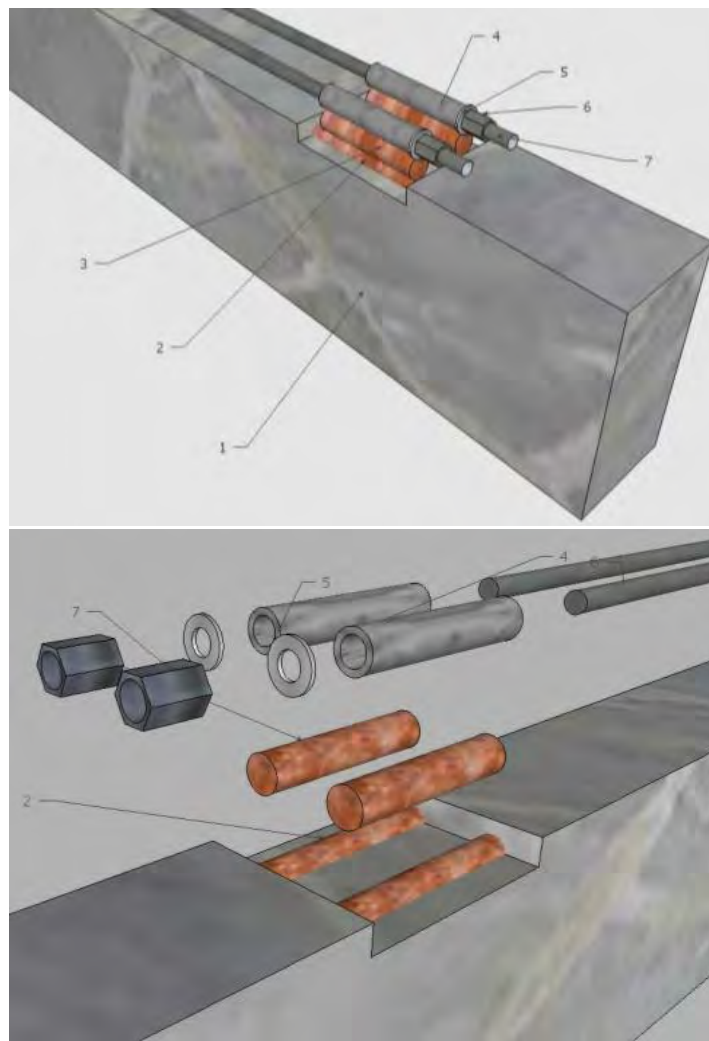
Схема монтажу необхідних елементів для кріплення та натягу додаткових арматурних стержнів:
